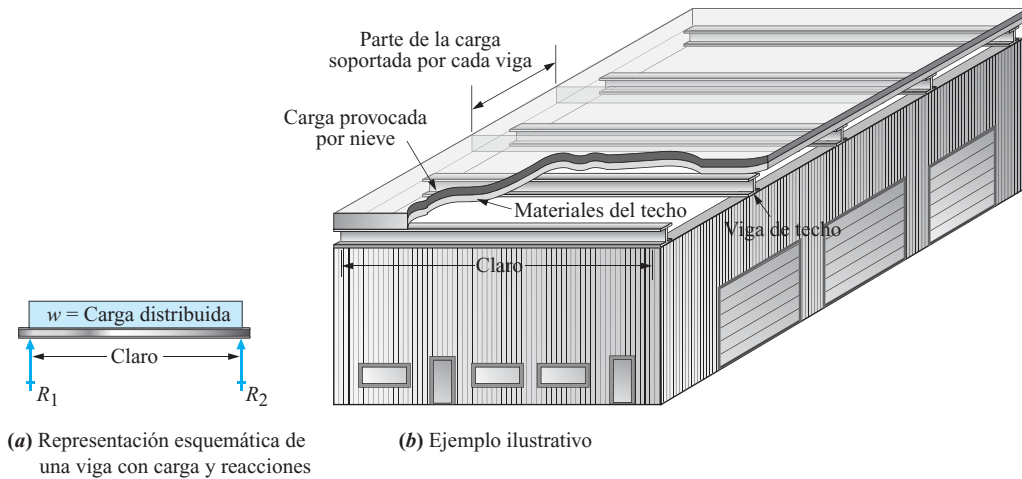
Viga simple con carga uniformemente distribuida.
